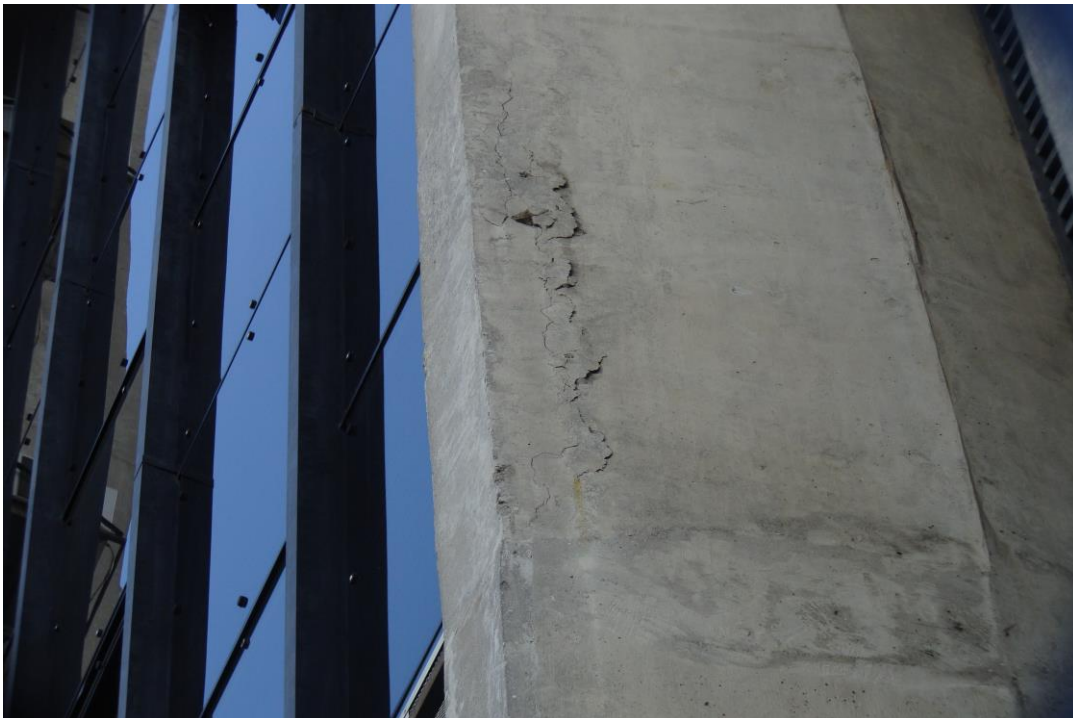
Armadura exposta pilar P13 (1º pavimento) (19/11/2013)
